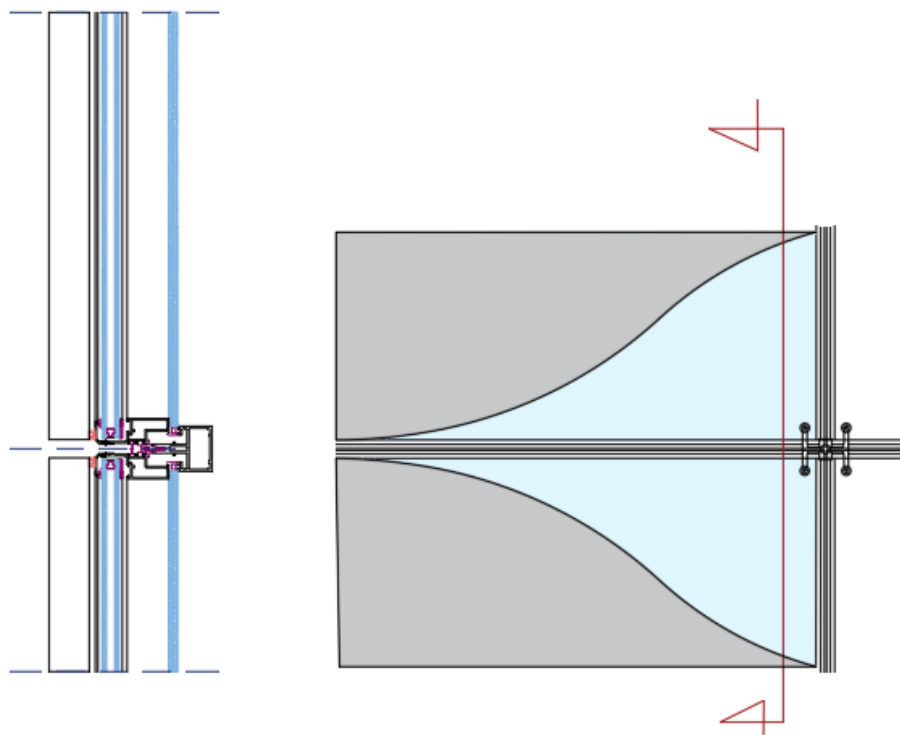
détail de fixation des panneaux en fibrociment en façade (source : auteurs).
